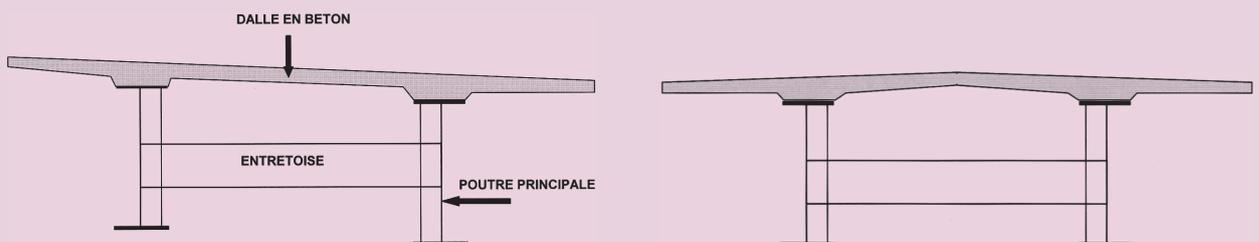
Bipoutre à entretoises (à gauche, cas d'une chaussée monodévers ; à droite, cas d'une chaussée à dévers en toit)
